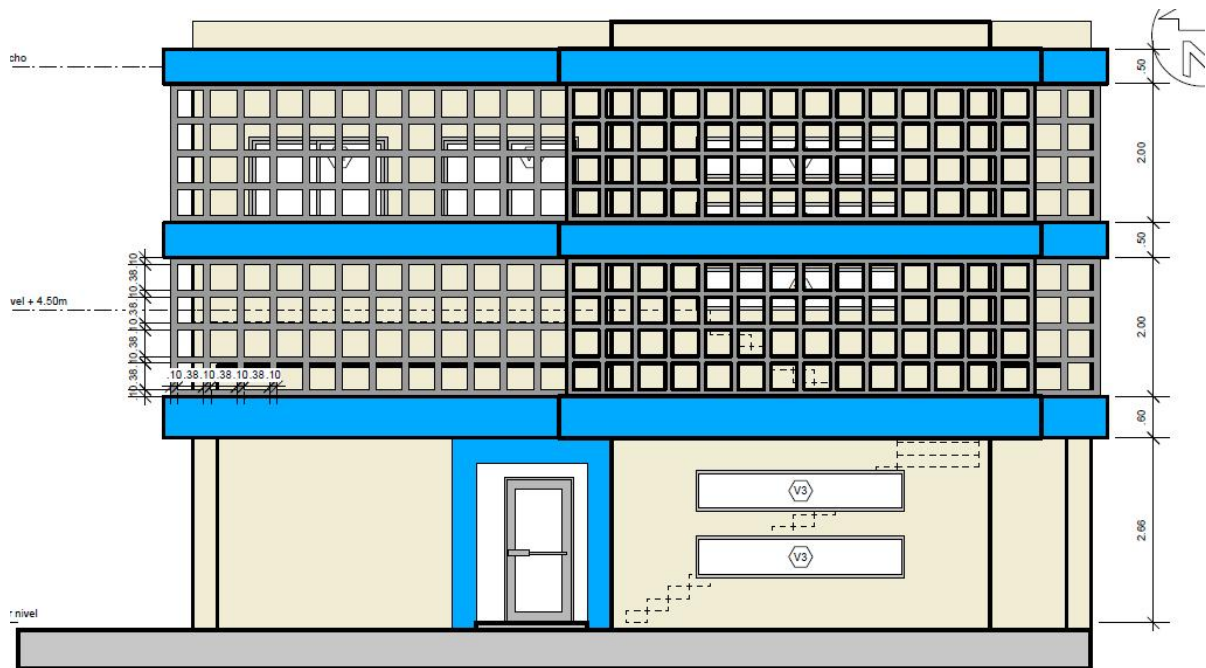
Plano estructura metálica Fachada Edificio Oficina Principal y Anexo Banco Ademi
